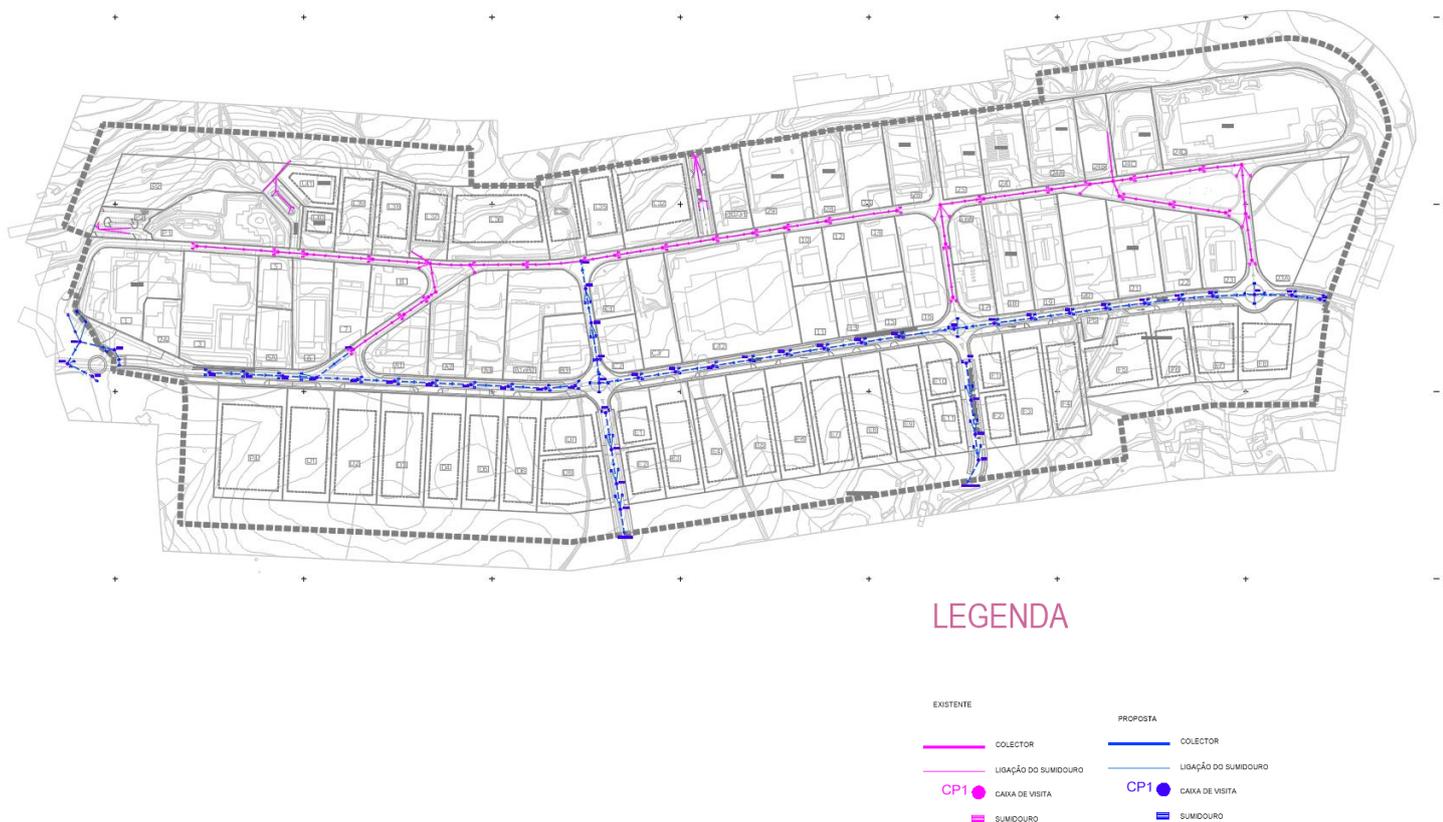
Sistema de drenagem de águas pluviais (e proposta) que serve a área do Plano da ZIOH.
